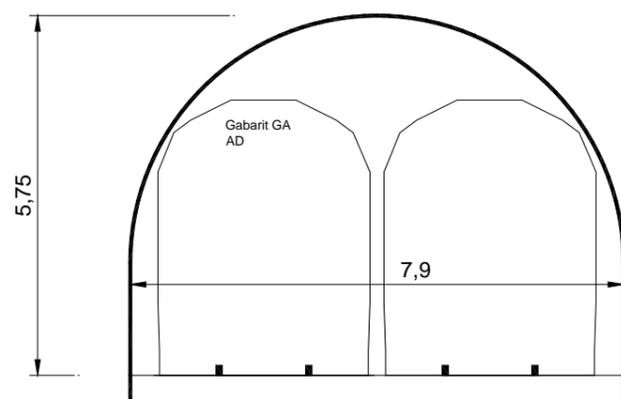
Coupe type avec le gabarit GA en alignement droit
